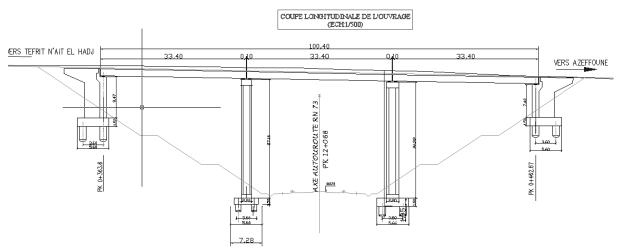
Pont a poutres multiples situé au PK12+100
